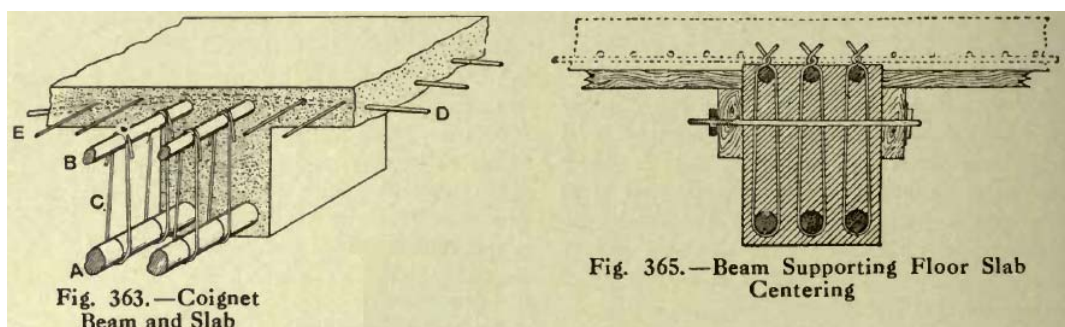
Pormenores de armaduras do sistema Coignet.
